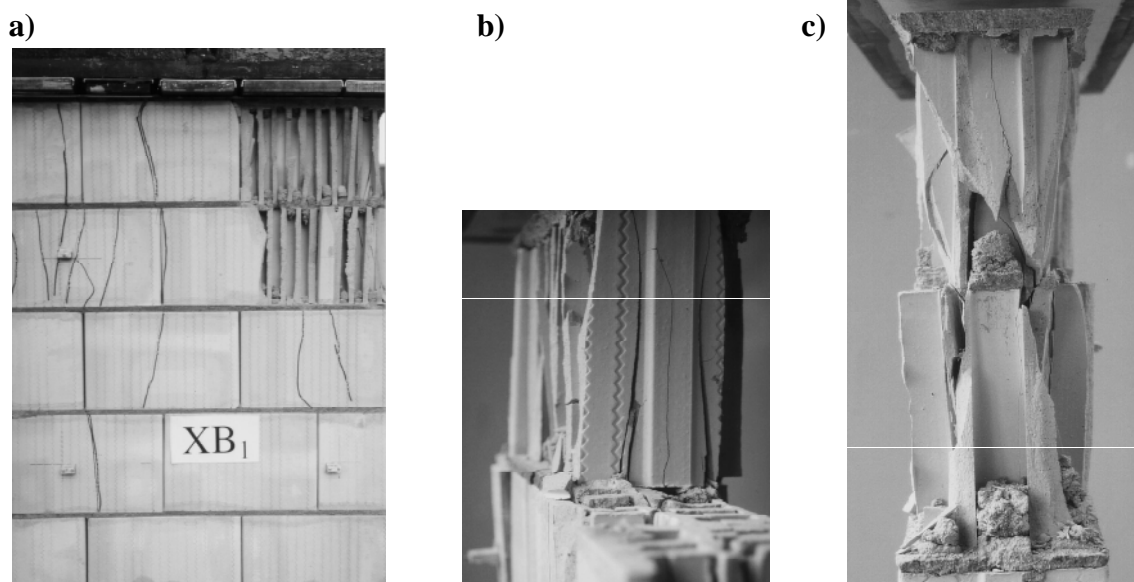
Bruchbilder: (a) Ansicht des Prüfkörpers XB1; (b) und (c) Detailaufnahmen.
